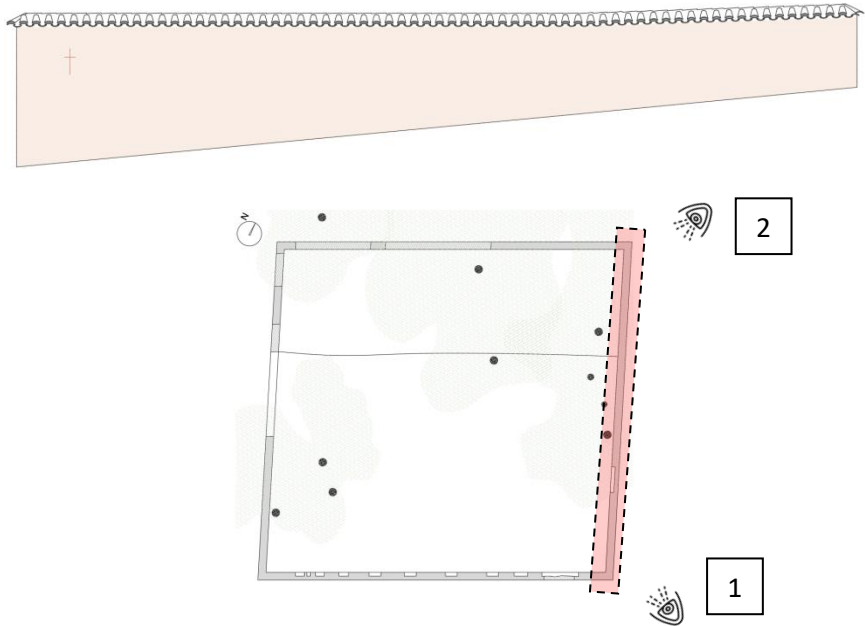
Esquema de planta-alzado fachada este. Fuente propia.
